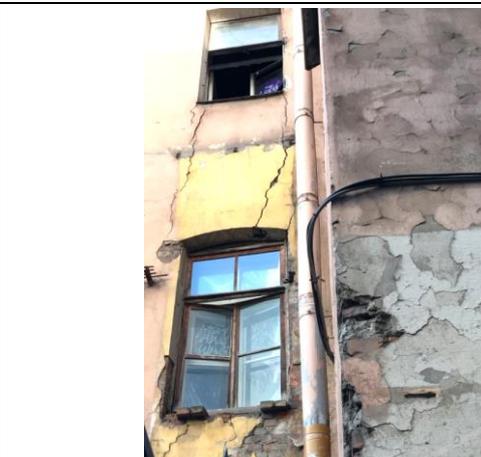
Состояние фасада здания со двора: трещины в стенах, отпадение штукатурного слоя
